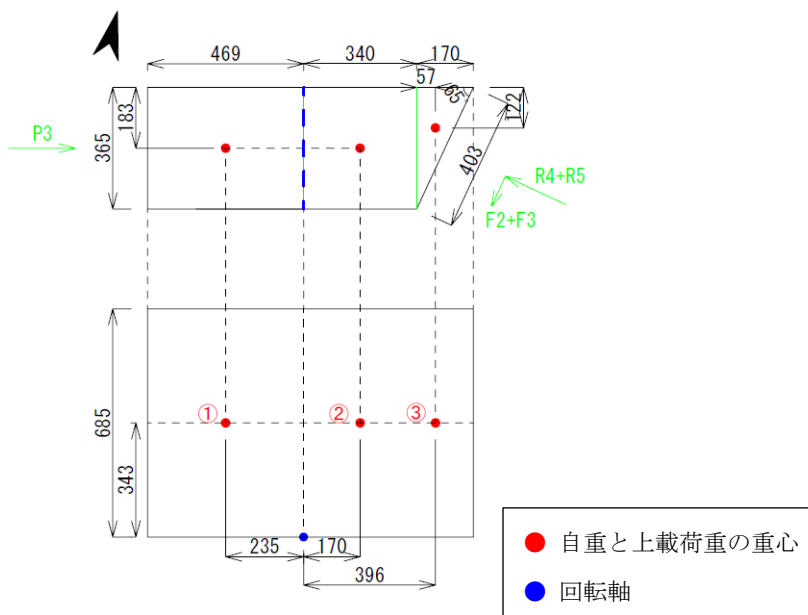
重心位置と回転軸からの距離 (C2-3) (単位 : mm)
